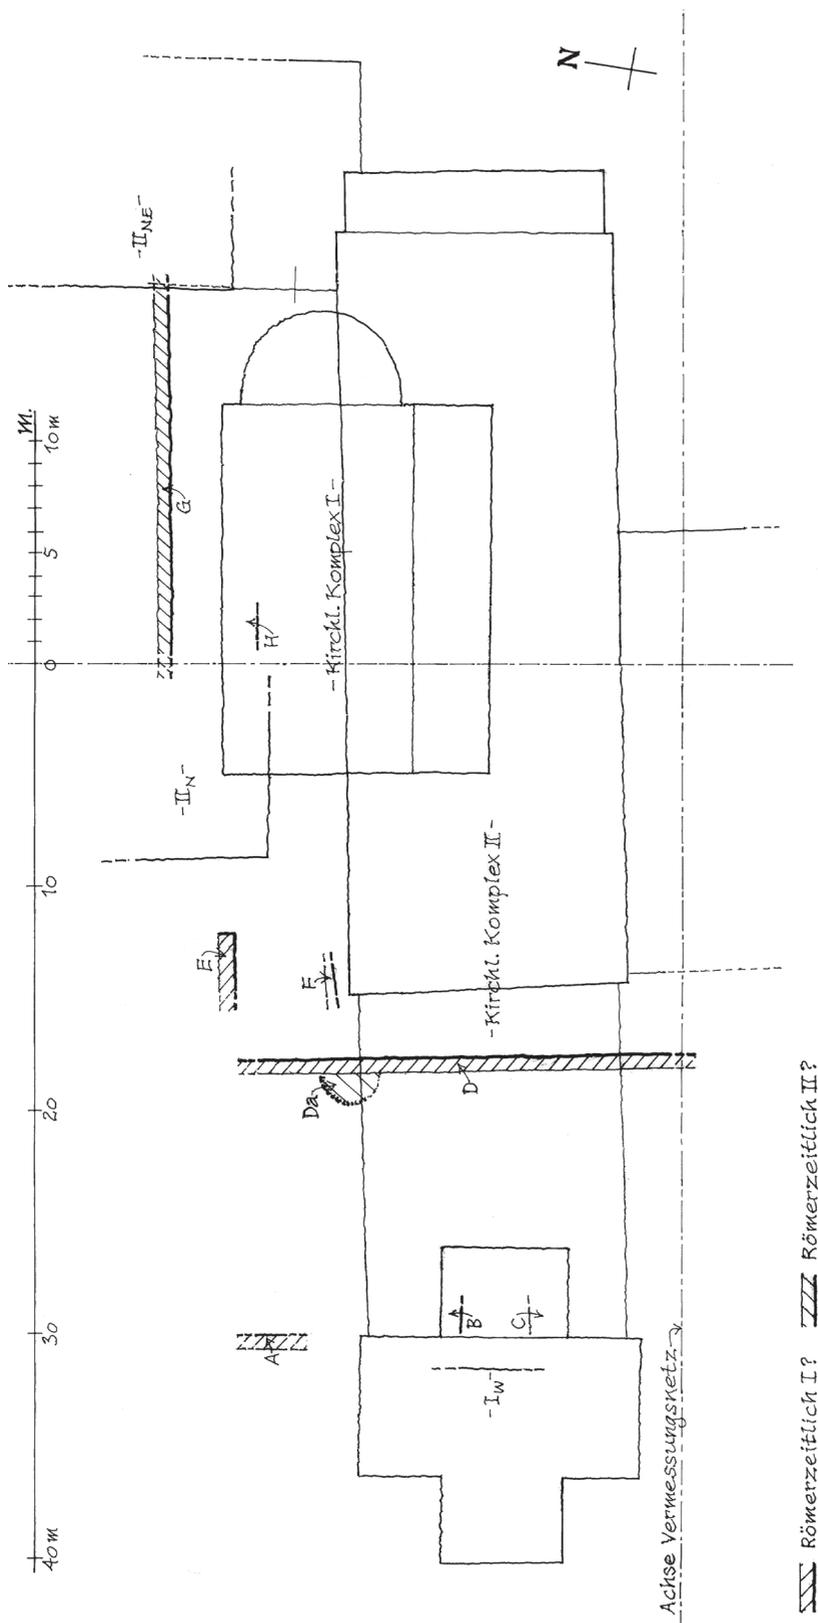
Benediktiner-Abtei Schuttern. Vereinfachter Grundriss der möglicherweise antiken Bauteile.
